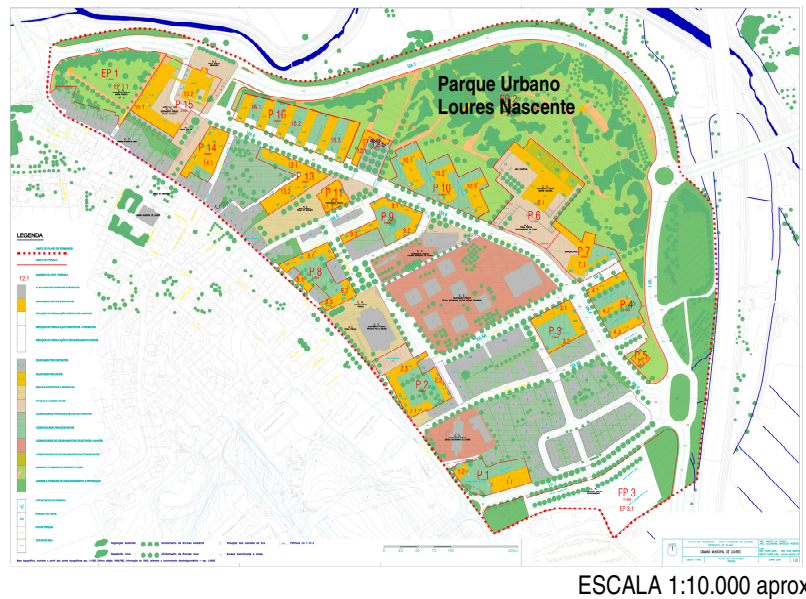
Planta de implantação do plano de pormenor da zona nascente de Loures, (Julho 2006)
